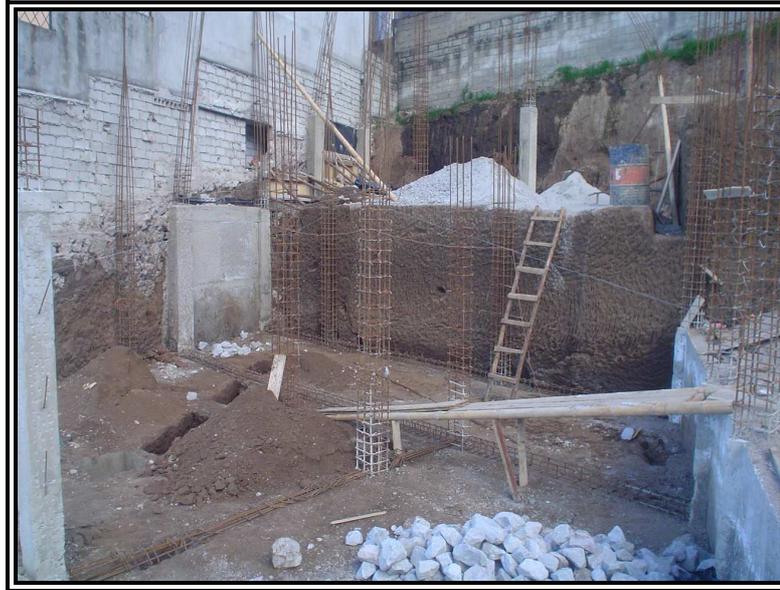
13 Construcción de Muros y levantamiento de columnas
